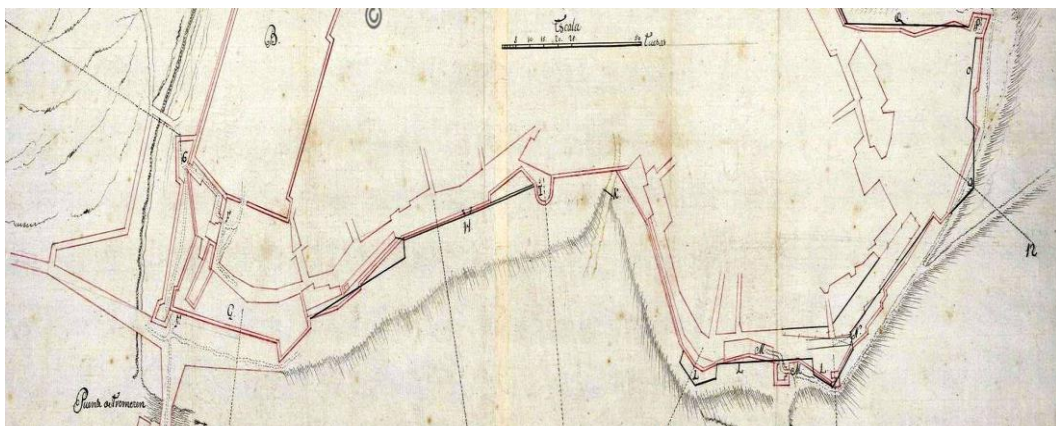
Plano y Perfil de los dos baluartes que se proyectaron de construir para la vigilancia de la Puerta de Canastel, bajo el gobierno de José Vallejo. Obras propuestas en el 10 de noviembre de 1734 por el ingeniero Ballester. AGS, MPD, 31, 013.
